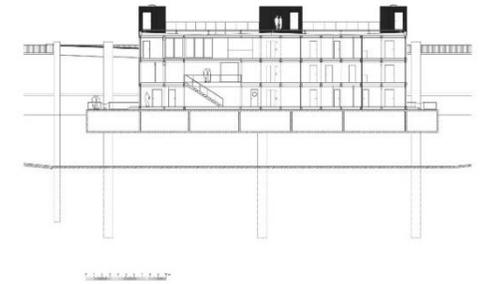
Sección del Iba Dock, 3 plantas + sótano + confinamiento.
